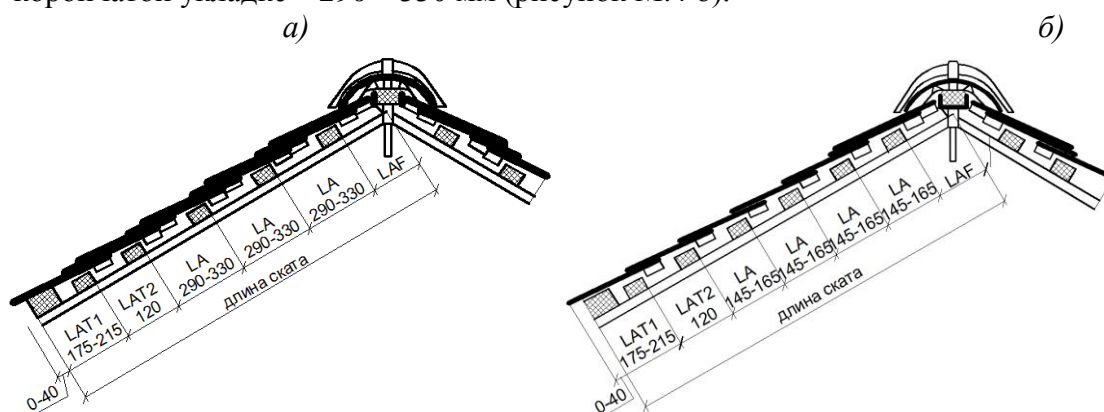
Поперечный разрез кровли (скат кровли) при двойной (а) и при корончатой (б) укладке черепицы
